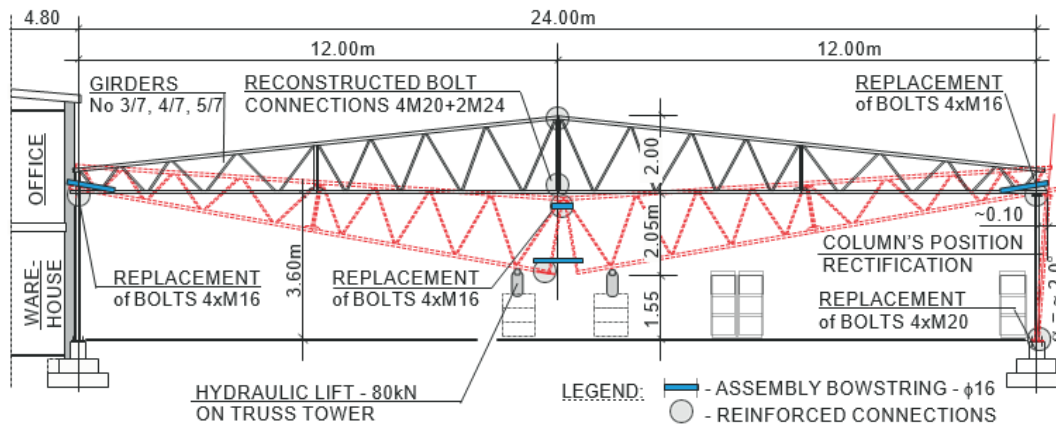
Mecanismo de elevación y estabilización de las dovelas de las vigas colapsadas
